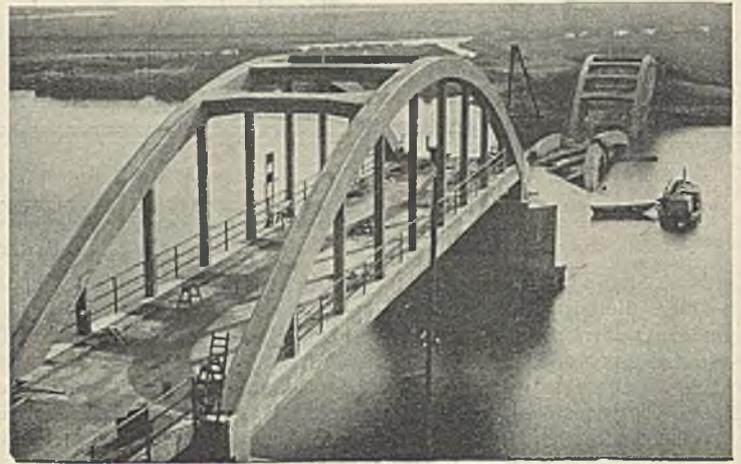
Die eingestürzte Eisenbetonbrücke.
